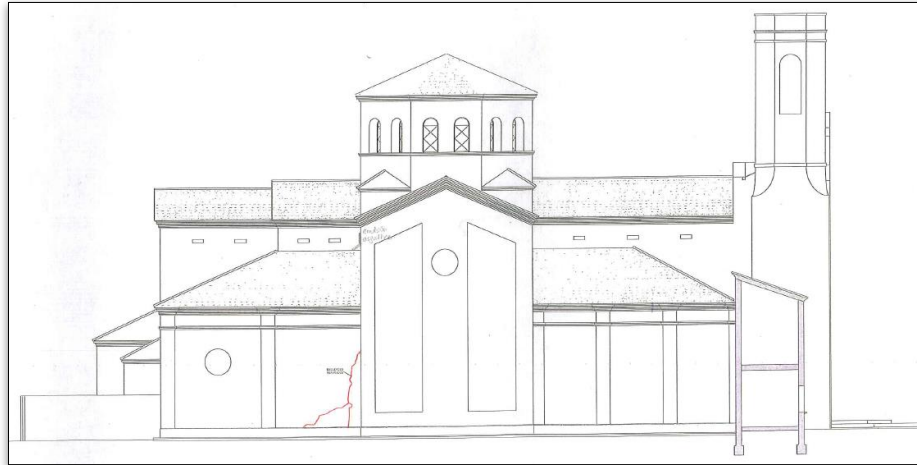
Grietas fachada oeste (plano PAT. 17)
